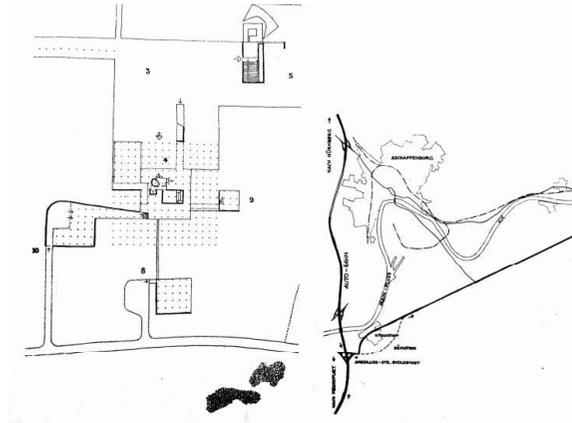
Centro Internacional de Arte de Erlenbach, en Frankfurt.
